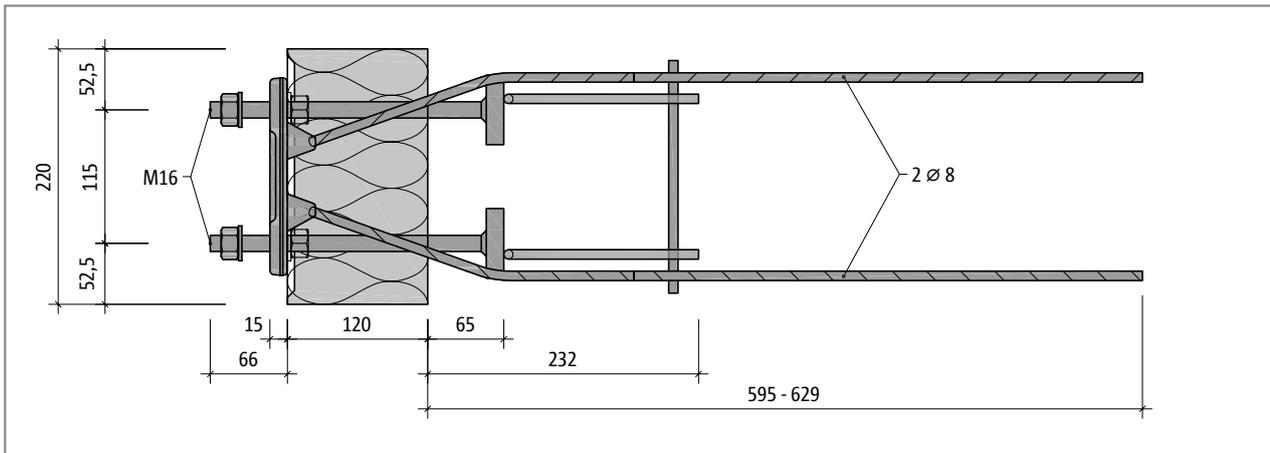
Schöck Isokorb® XT Typ SQ-V1: Grundriss
